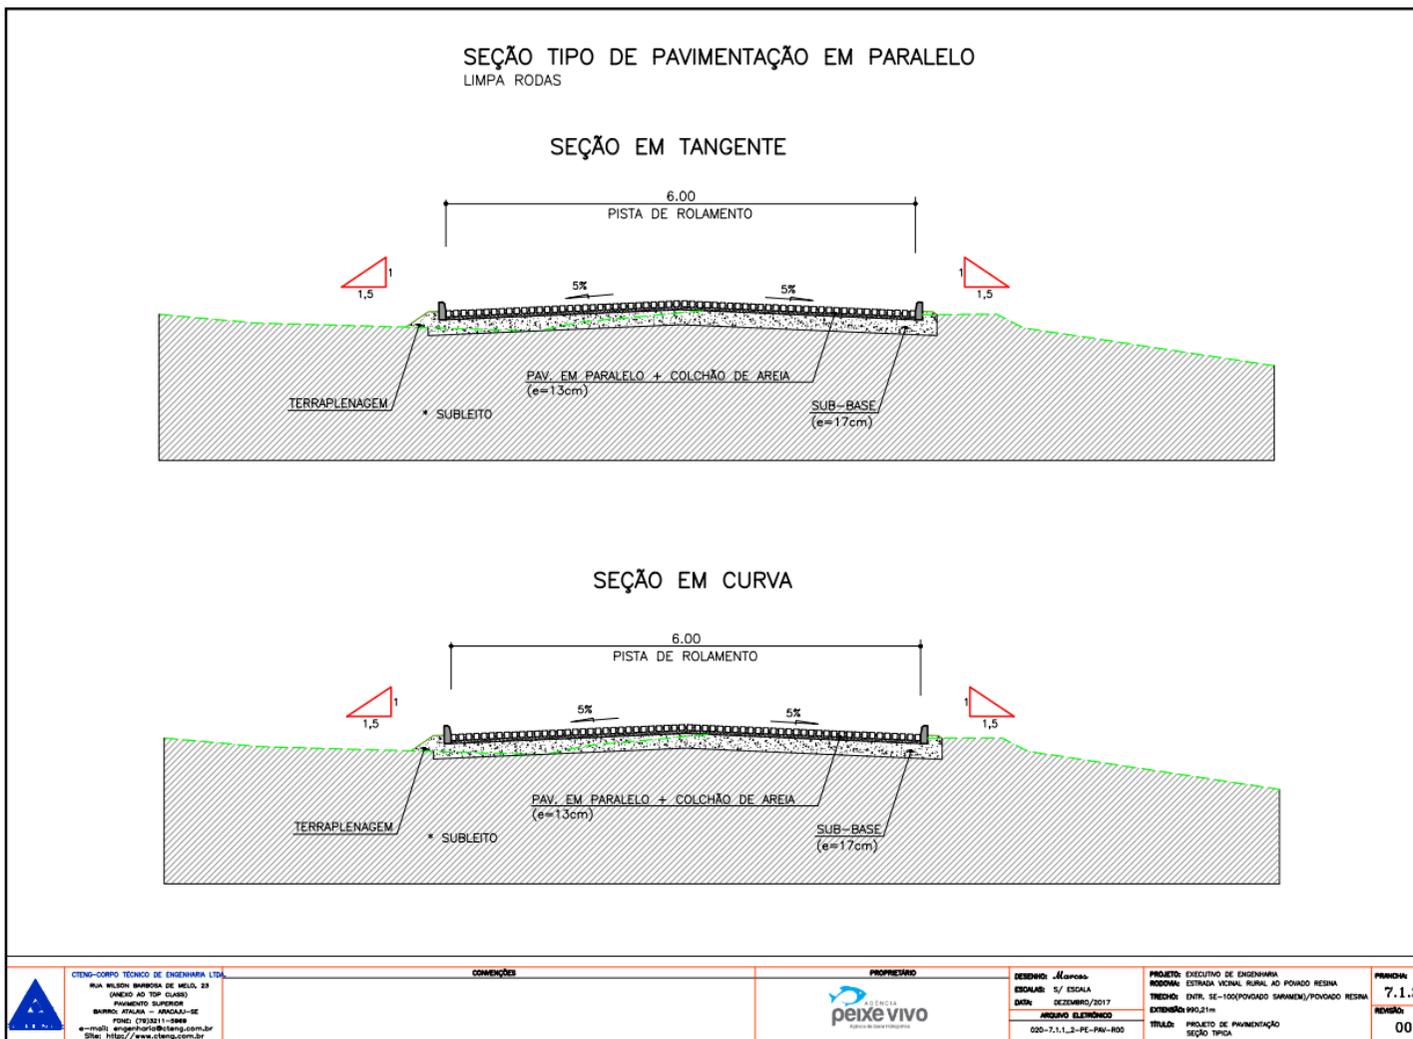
b - Seção típica do projeto de pavimentação (limpa rodas).
